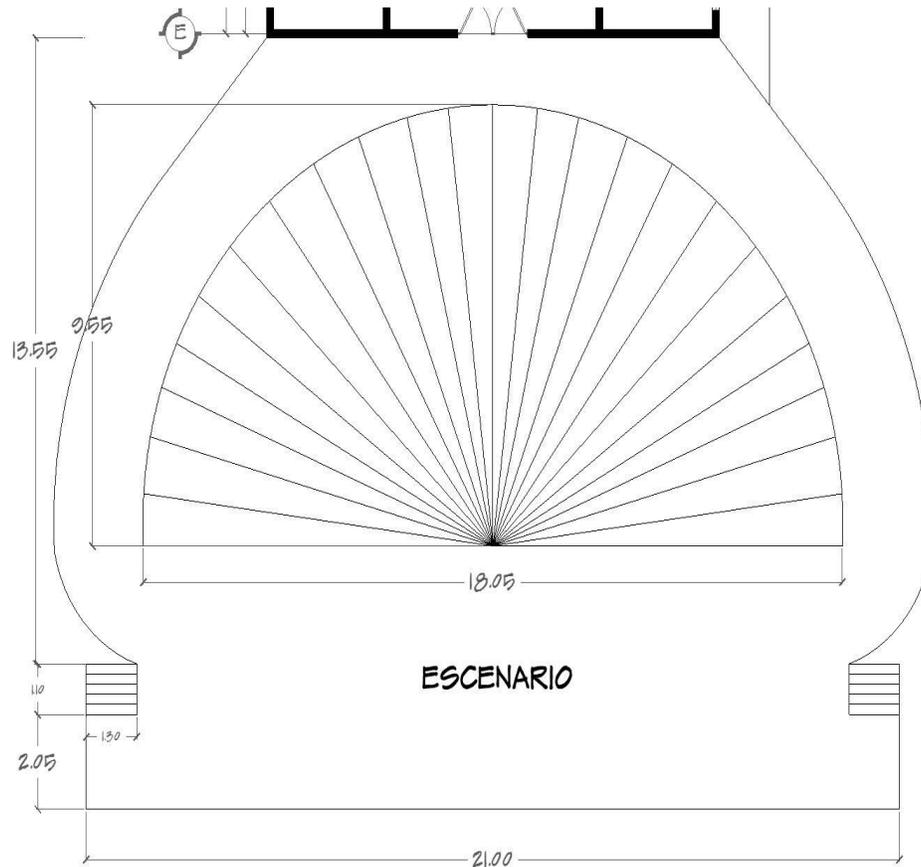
Plano dimensionado del escenario de la Concha Acústica de la E.V.A.
